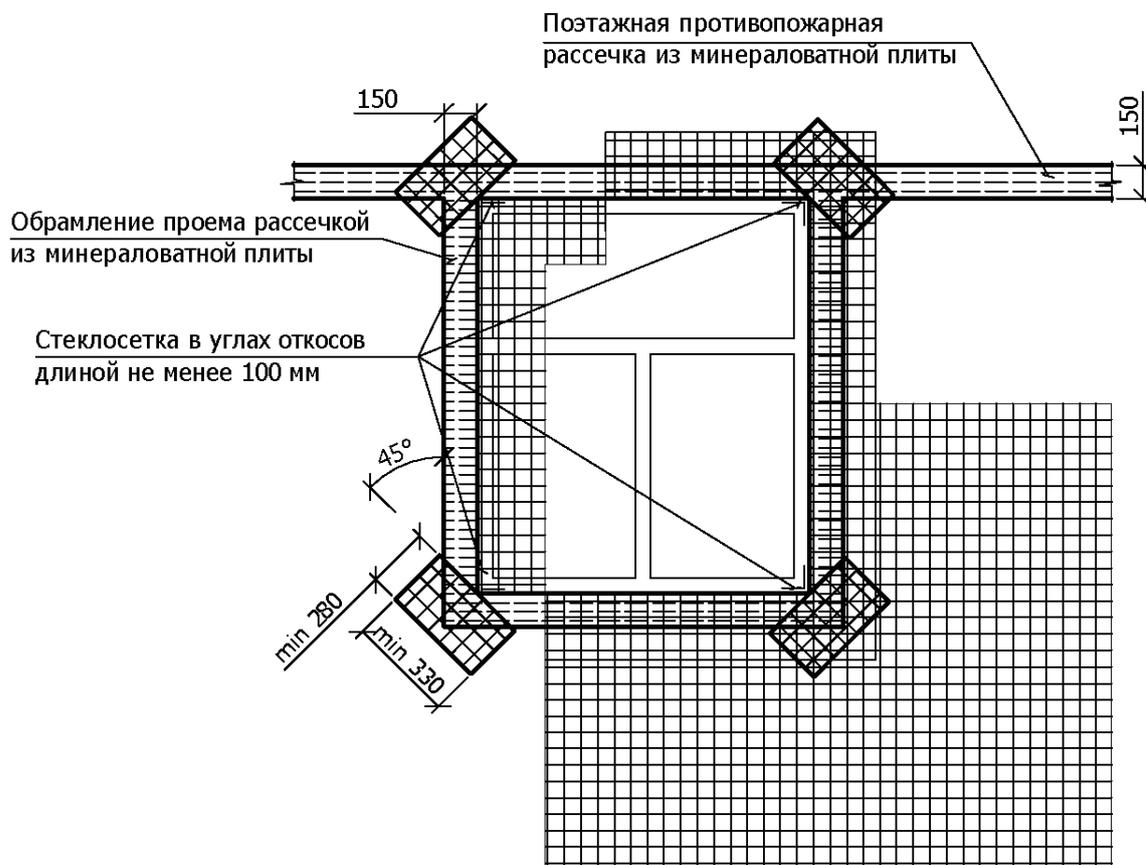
Система наружной теплоизоляции фасадов с применением в качестве утеплителя минераловатных плит ЛАЭС-М
